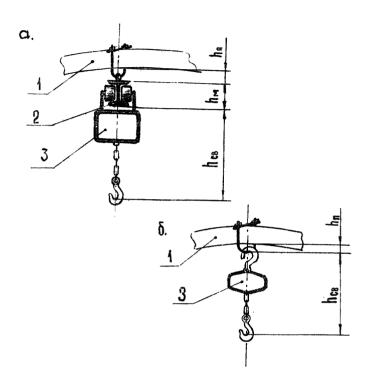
Схема узла подвешивания грузоподъемного оборудования в горной выработке:
